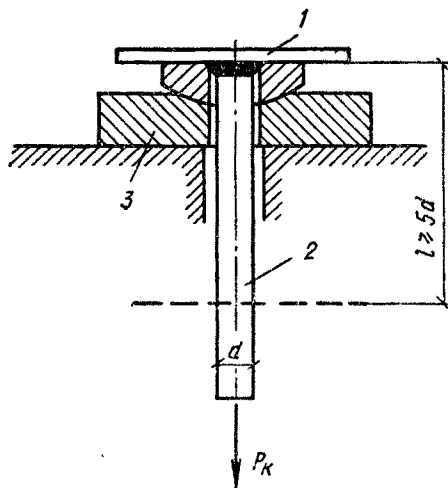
Схема испытания на отрыв контрольных образцов сварных соединений арматурных стержней втавр с плоскими элементами закладных деталей
